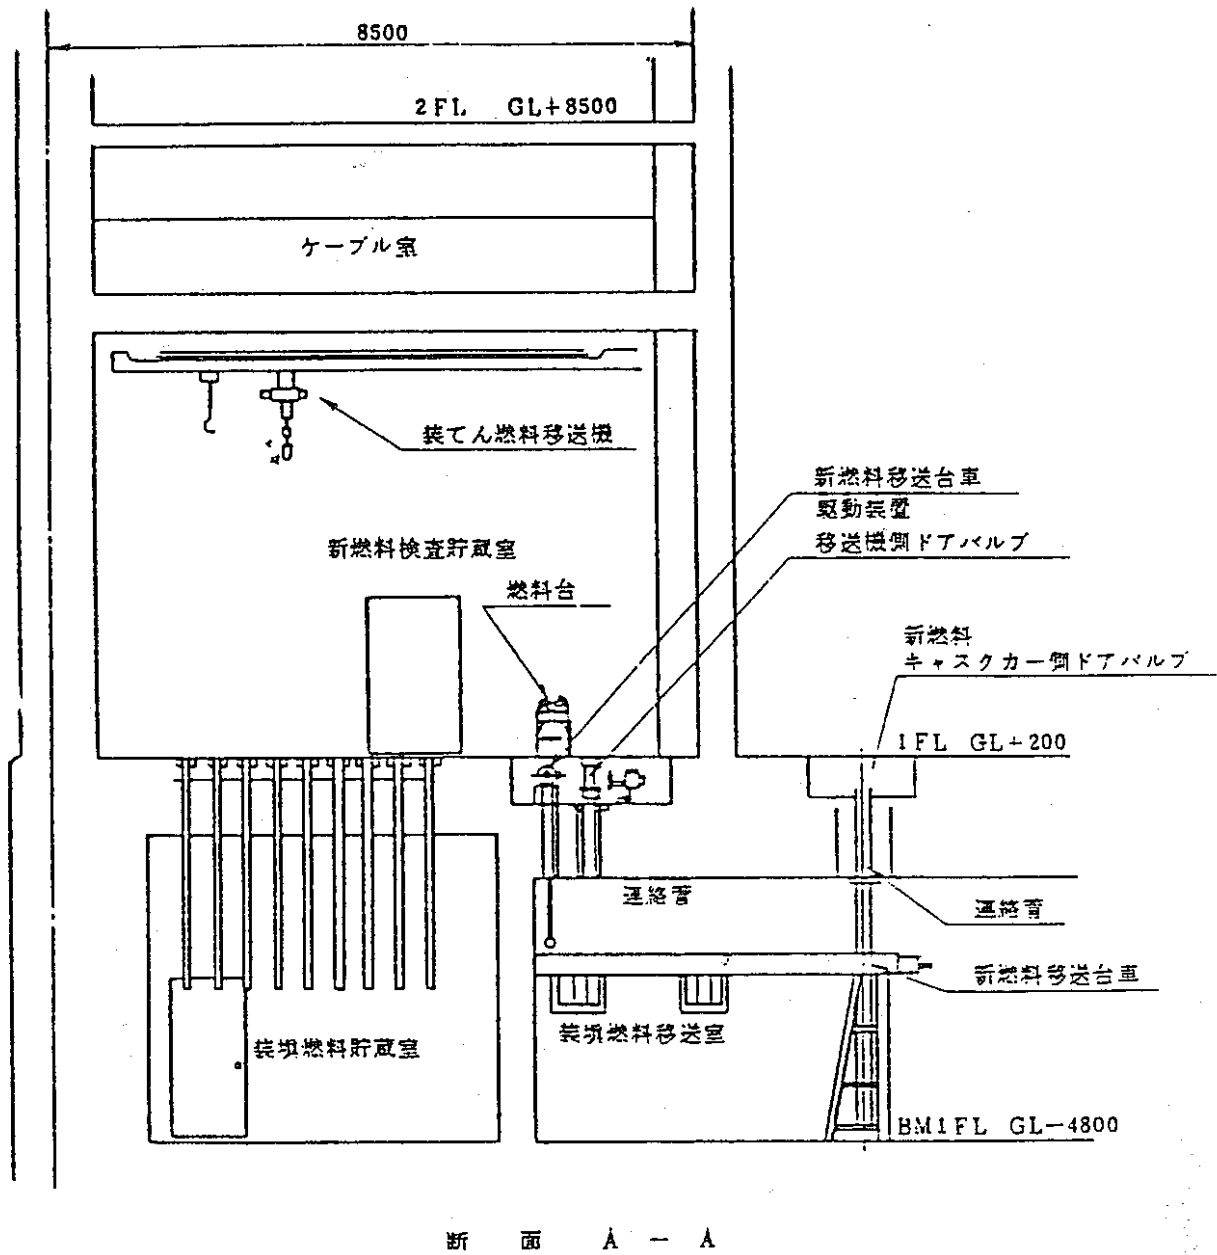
新燃料貯蔵設備配置図 (縦断面図)
